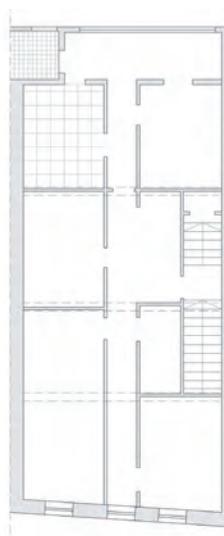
ATZIETA 6. PRIMERA PLANTA
